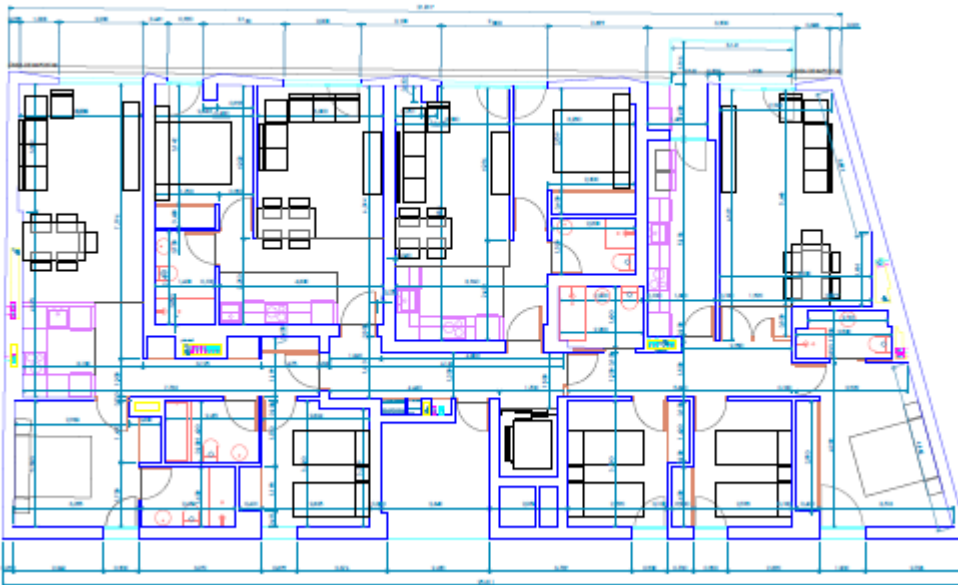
Viviendas planta 2 y 5. Fuente: Propia
